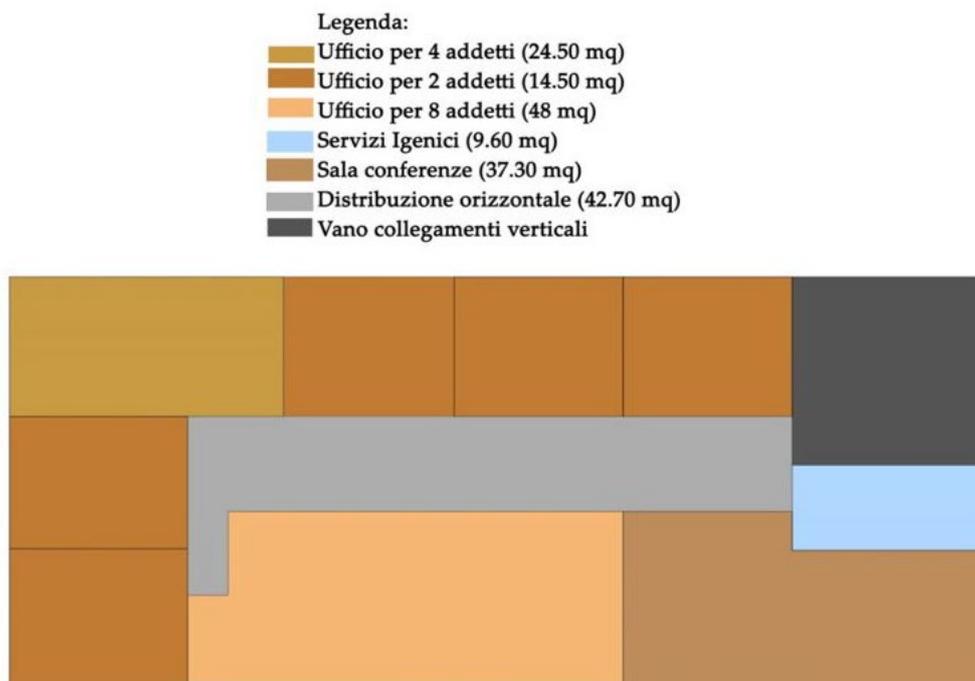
Legenda e planimetria schematica del piano tipo dell'ufficio.
